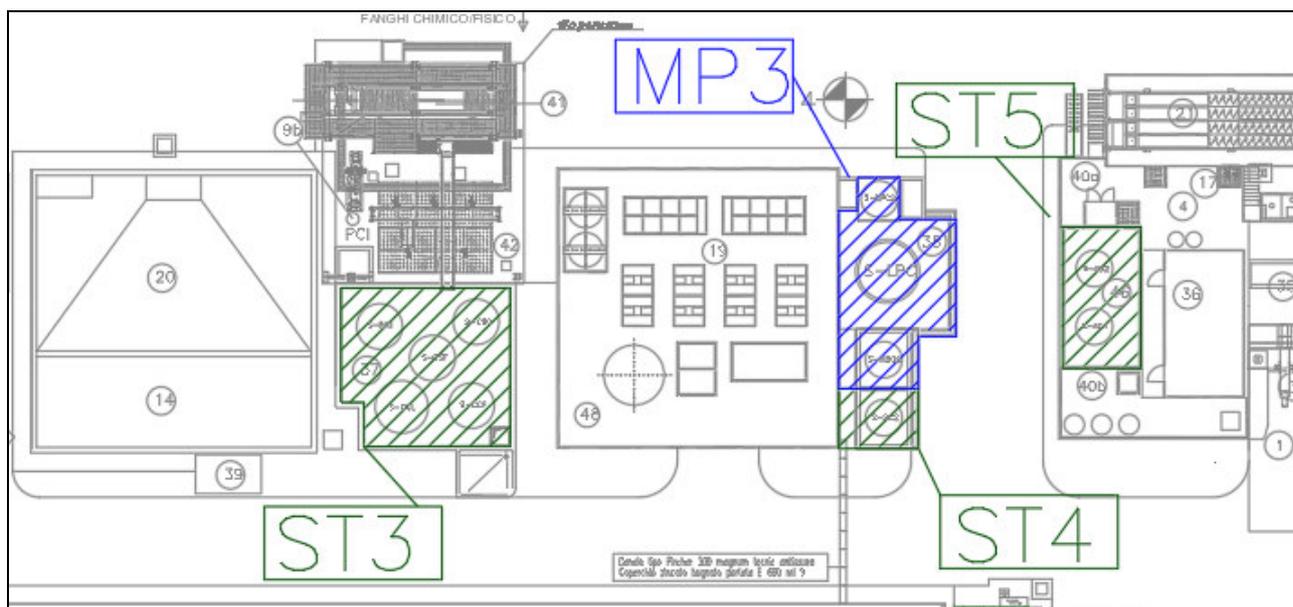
stralcio della planimetria depositi e stoccaggi dell'impianto – stato di progetto (MP: depositi reagenti/materie prime; ST: corpi tecnici destinati all'operazione D13)
